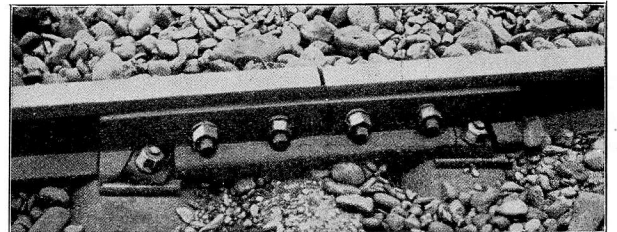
Zerreißen der eisernen Schwellen und Einfressen der Laschen in die Klemmplatten.
